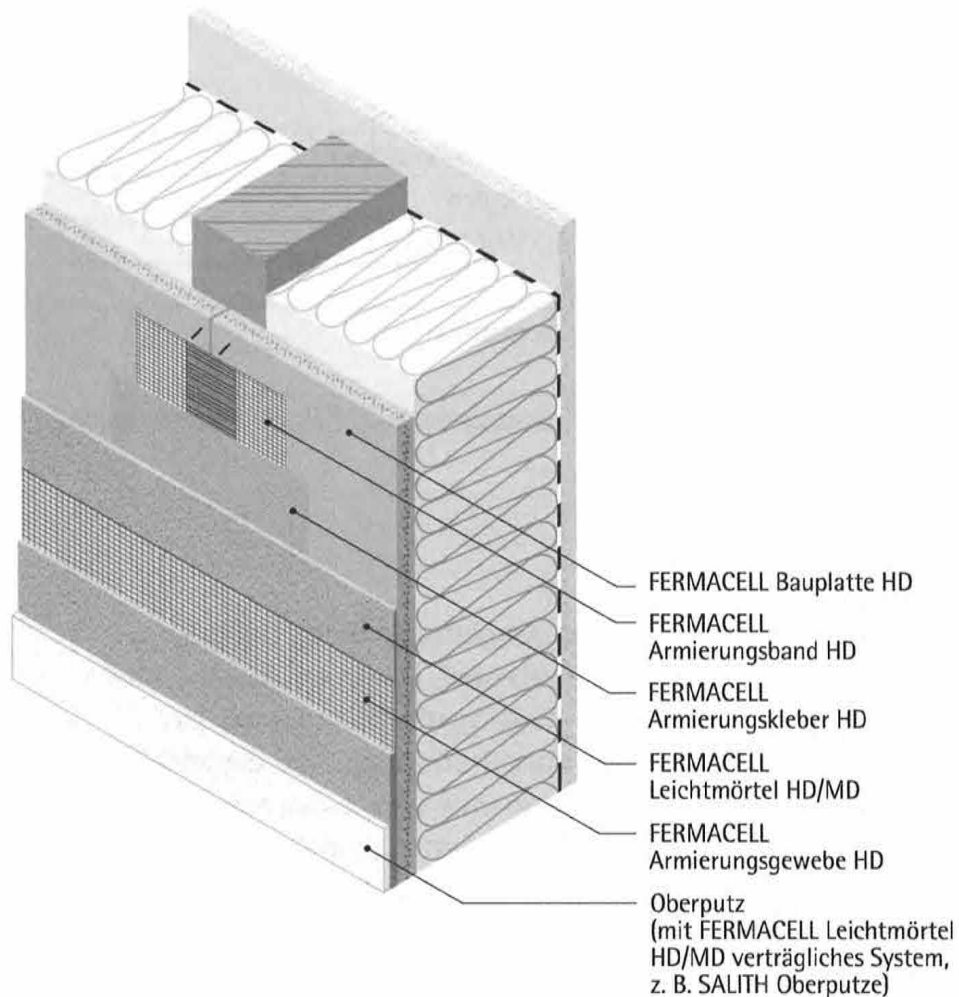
Systemaufbau einer Aussenwand mit der FERMACELL® Bauplatte HD
